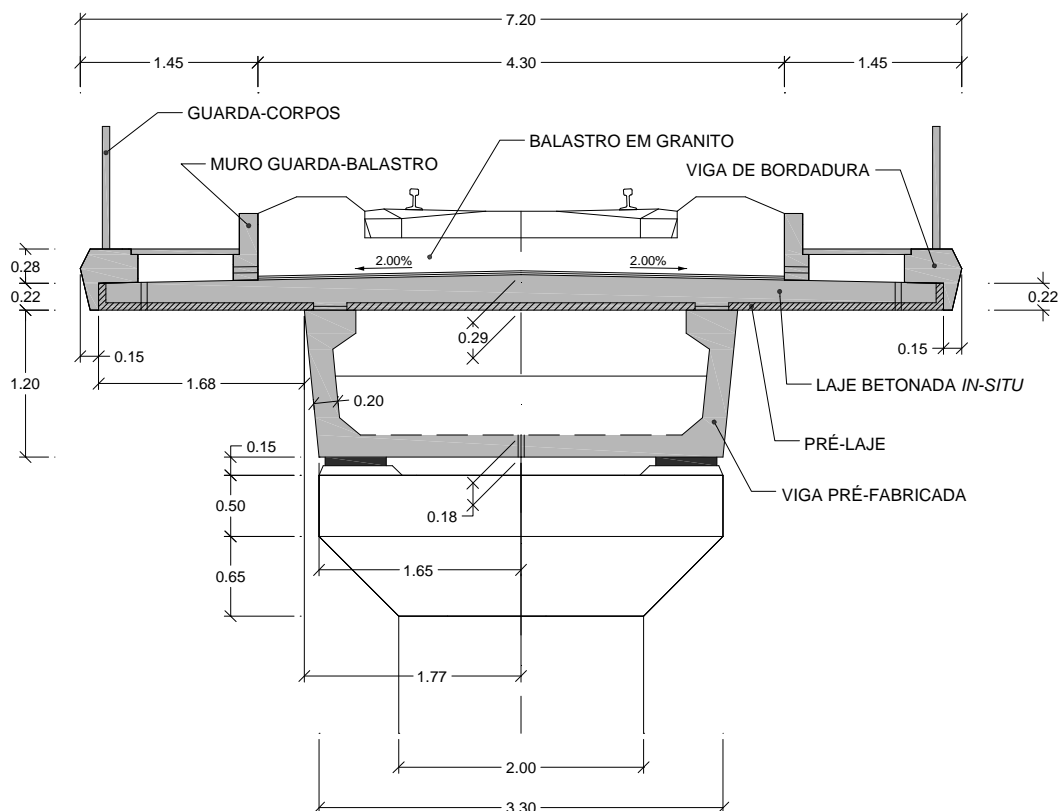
Secção transversal do viaduto na zona dos apoios
